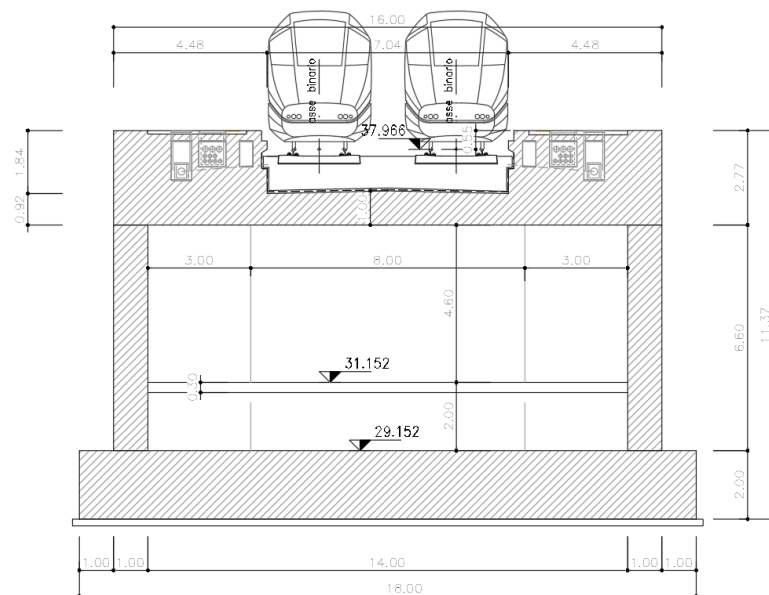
Scatolare di Stazione - Sezione trasversale
